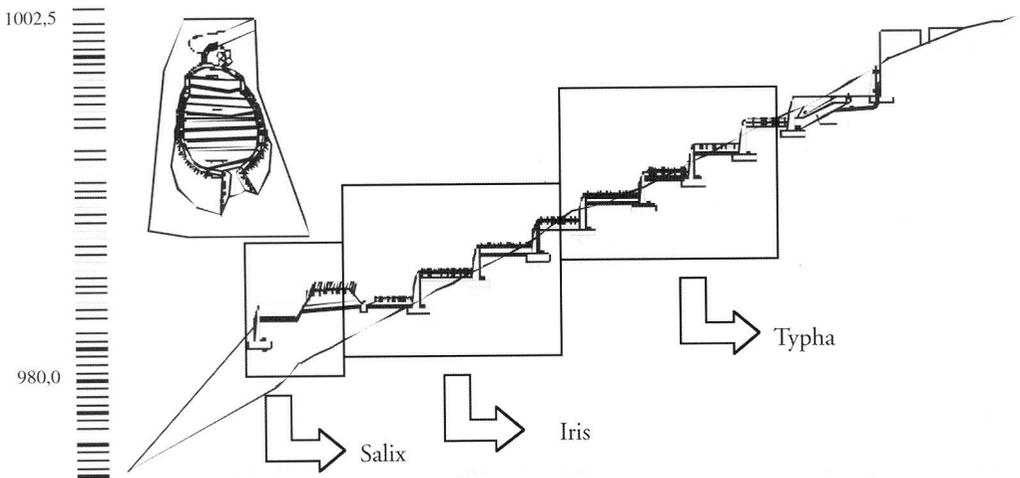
Esquema en planta y en sección longitudinal de la estación depuradora de Cantejeira
